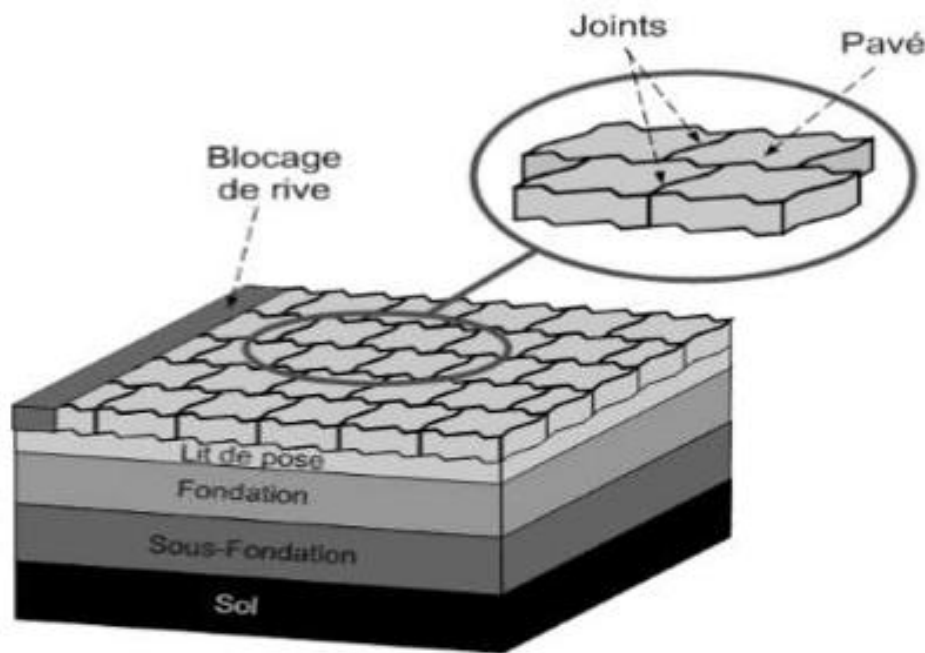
Dessin type d'une chaussée revêtue de pavés [13]
